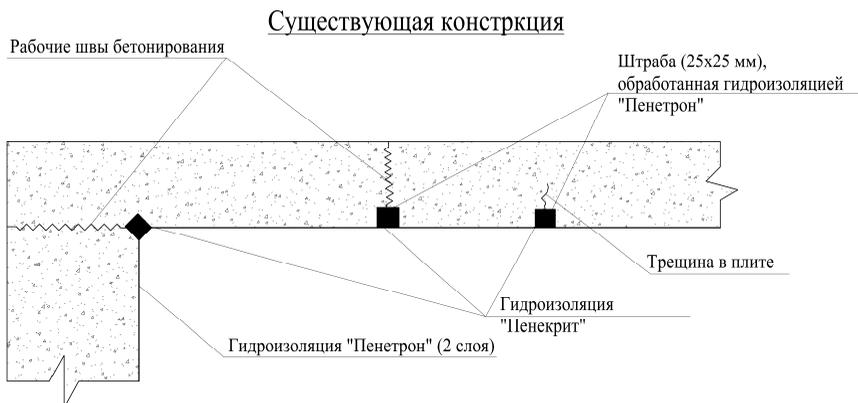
Б. Вариант 3. Защита монолитной фундаментной плиты и монолитной плиты стены с использованием гидроизоляции «Пенекрит», введенную в штрабу 25×25, обработанной составом «Пенетрон»
